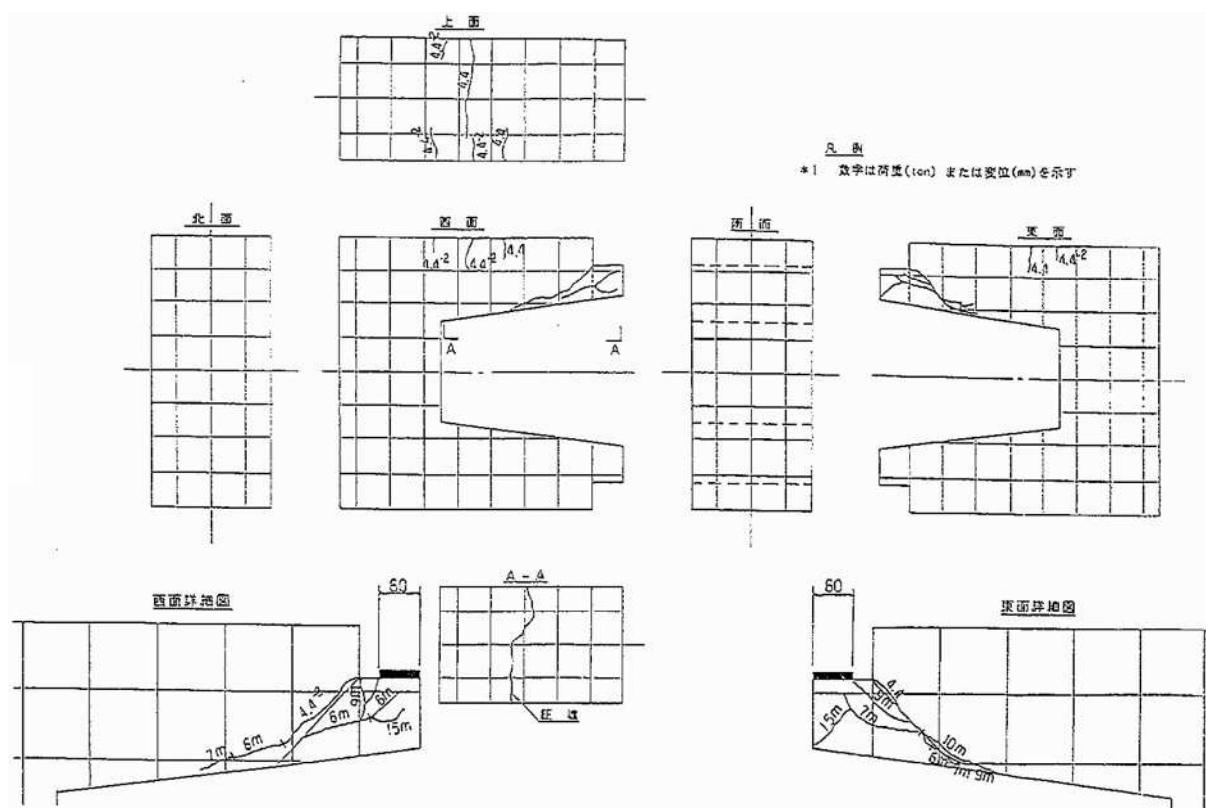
切欠部供試体(その 1)ひび割れ図(掛かり長 60mm) (単位:mm)
